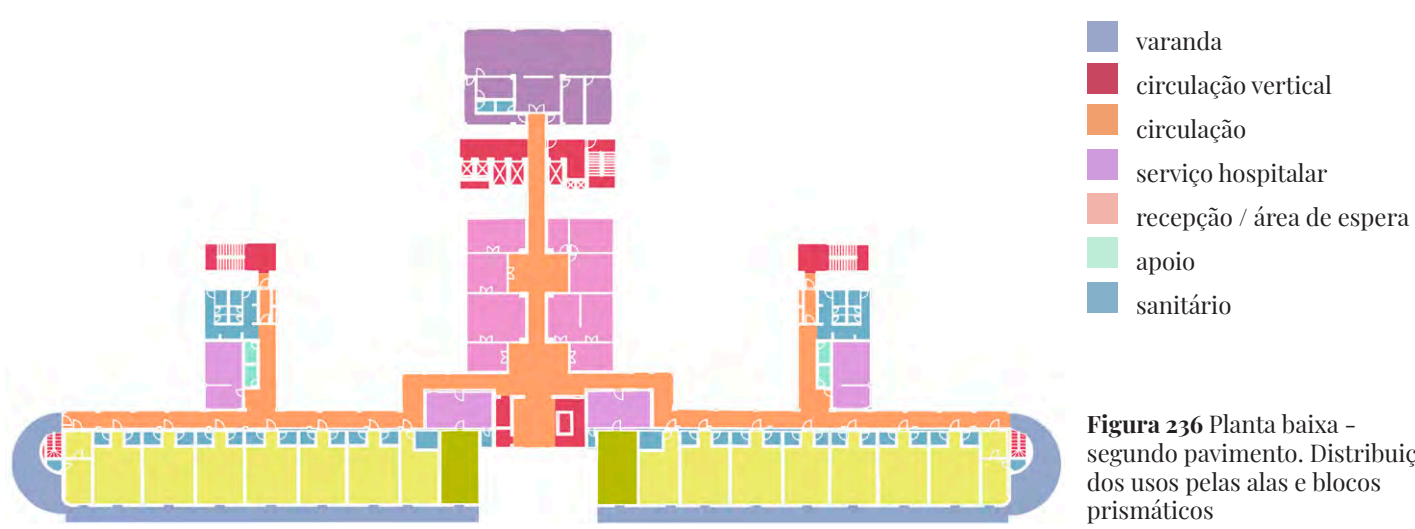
Planta baixa - segundo pavimento. Distribuição dos usos pelas alas e blocos prismáticos
